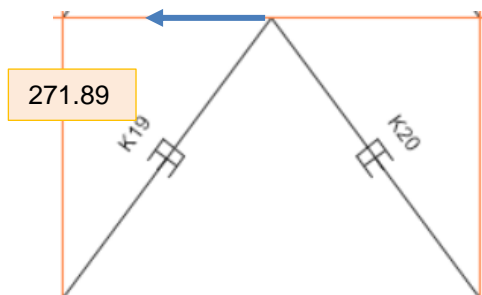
Fuerza axial del disipador K19 con 1.5 veces el sismo severo.
